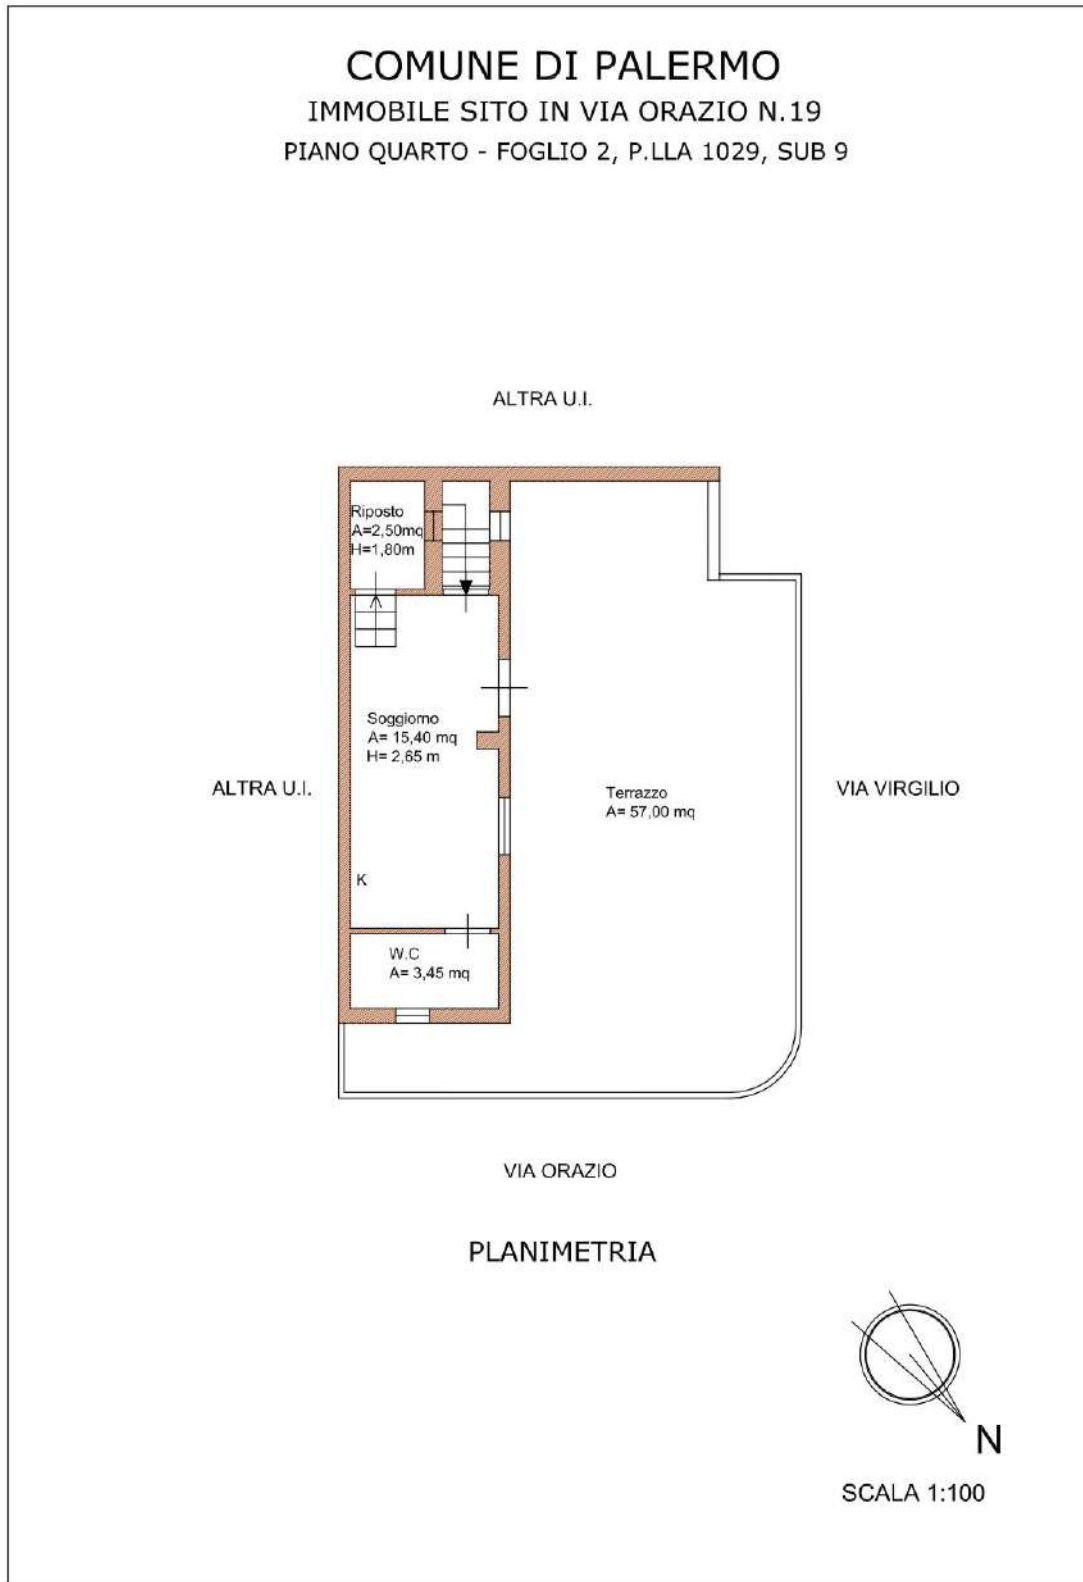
Planimetria bene pignorato ai fini della vendita all'asta
